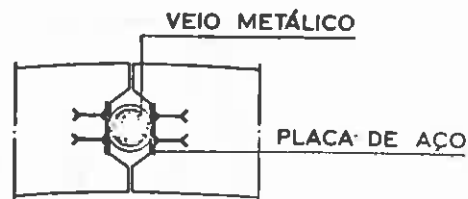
Pormenor de apoio fixo de arco atirantado com articulação de betão armado
